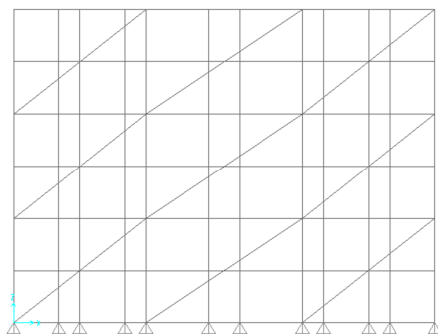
Configuração dos Planos de Contraventamento Vertical Com Elementos de Contraventamento Grandes
